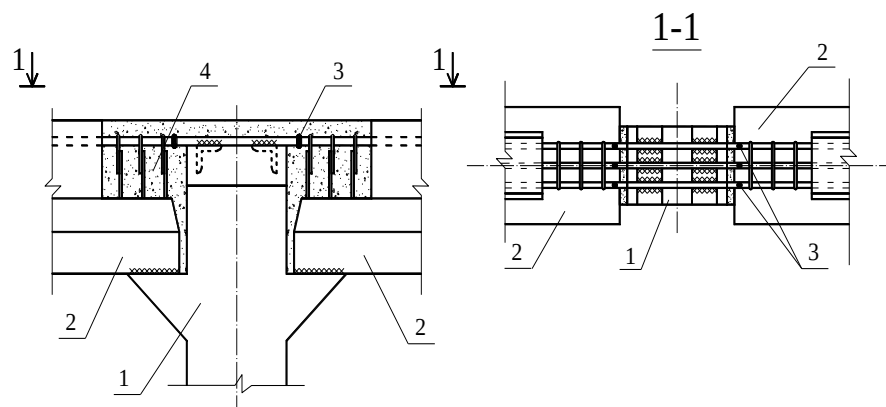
Сопряжение сборных поперечных ригелей покрытия с колонной: 1 – колонна; 2 – ригель; 3 – ванная сварка; 4 – бетон замоноличивания
